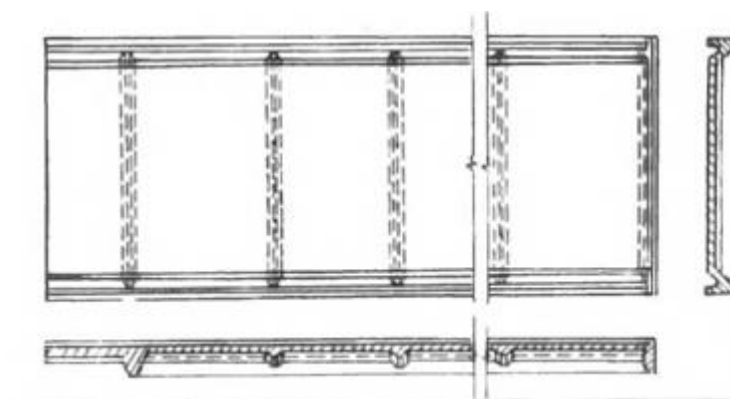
Пример кровельной плиты складчатого сечения с полкой в сжатой зоне для крыш с наружным водоотводом
